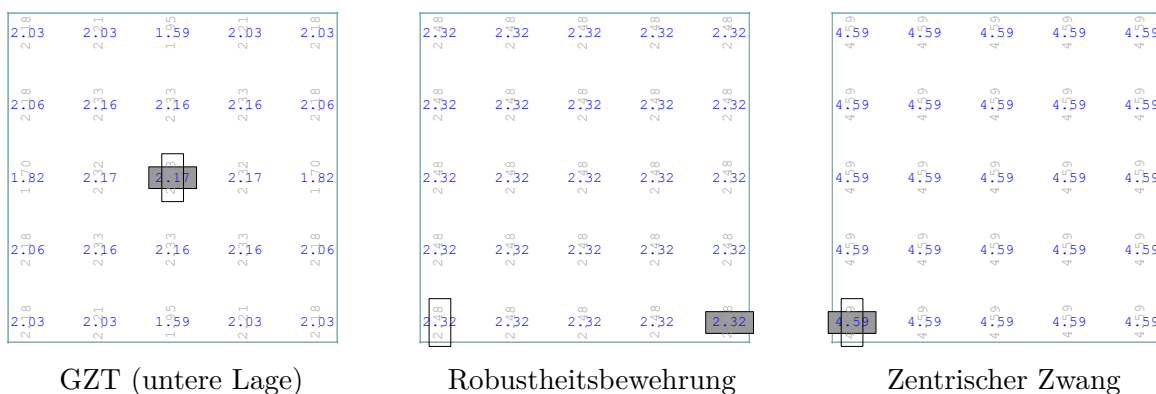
Erforderliche Bewehrung [cm²/m] für die Stahlbetonflachdecke – $L = 5,0$ m
